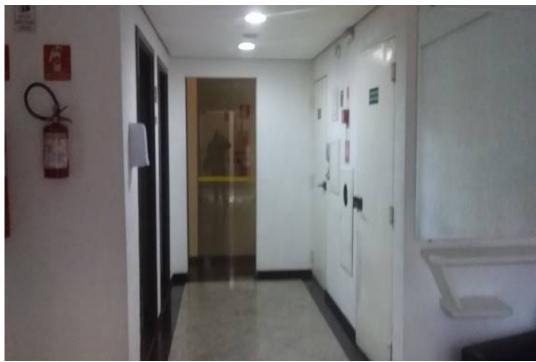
Vista do hall de acesso aos elevadores.
